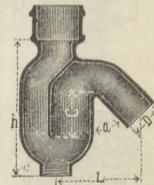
Geruchverschluß mit großem Wasserquerschnitt.
